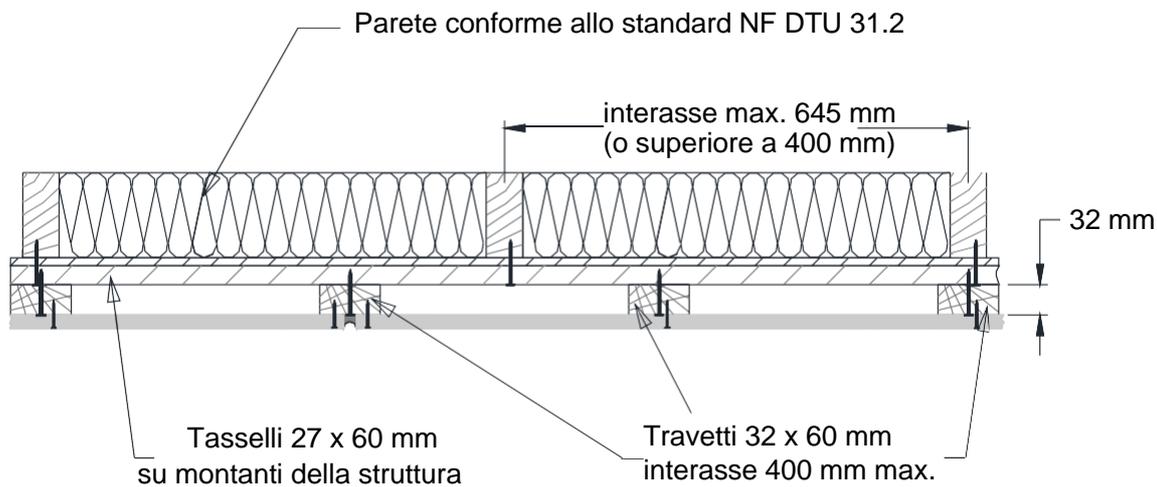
Sezione orizzontale su costruzione con struttura in legno – Posa orizzontale (interasse > 400 mm) – Posa su doppia travatura
